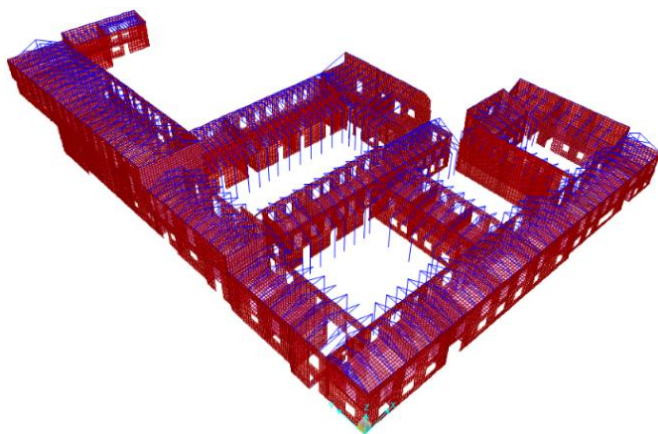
Modelo de estructura reforzada con viga cabeza de muro. SAP2000 v15.2.1
